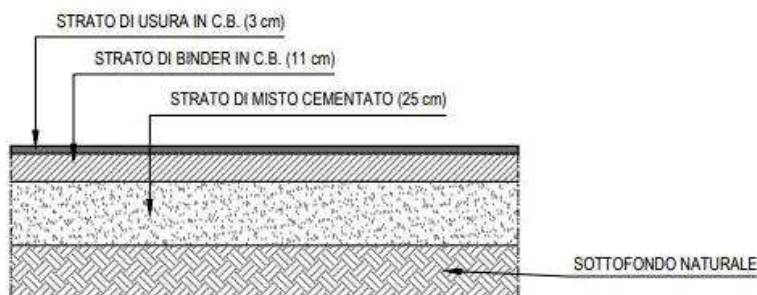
Dettaglio pavimentazione ciclabile in conglomerato bituminoso
